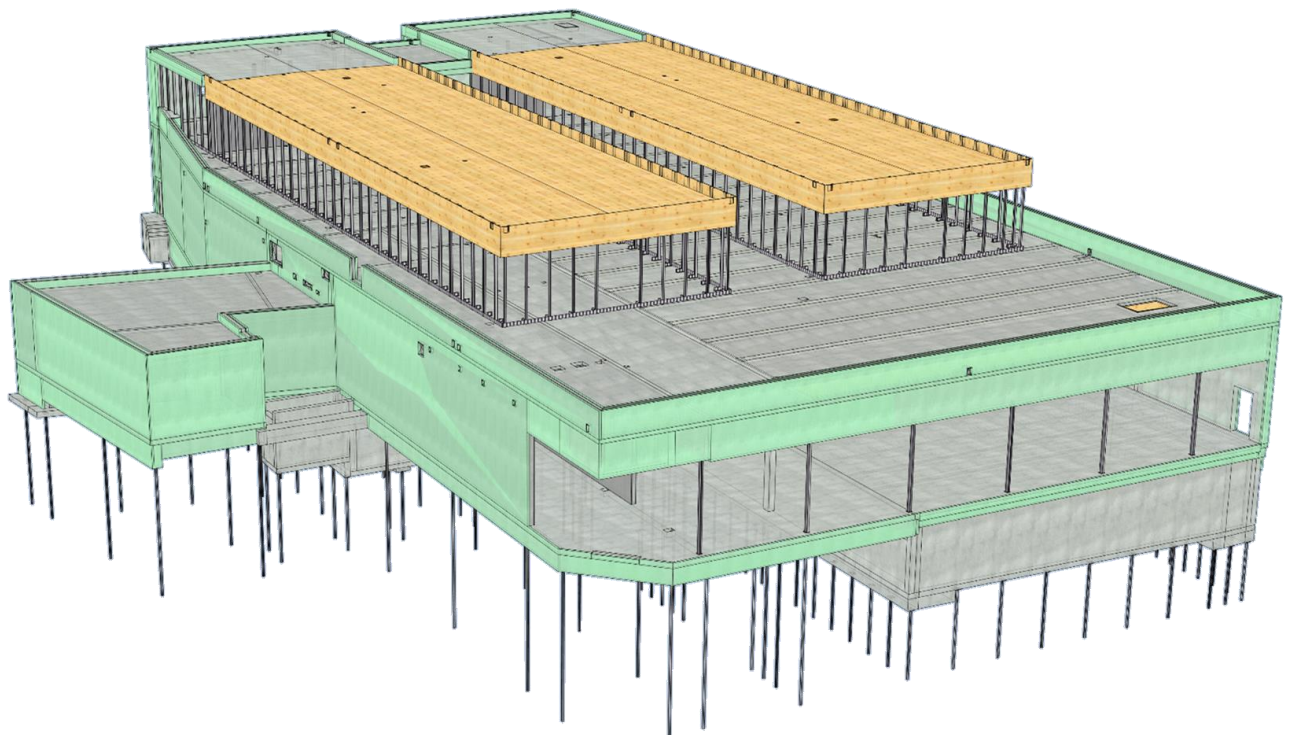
3D-CAD-Modell des fertig geplanten Tragwerks mit Allplan
